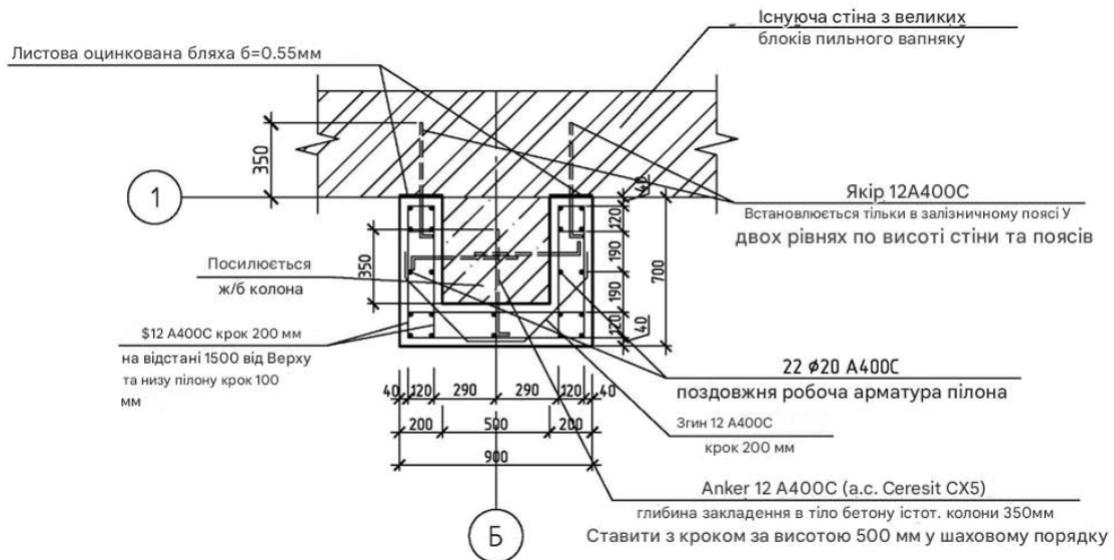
Схема підсилення монолітної залізобетонної колони будівлі з огорожувальними стінами з великоблокового пильного вапняку (у плані)
